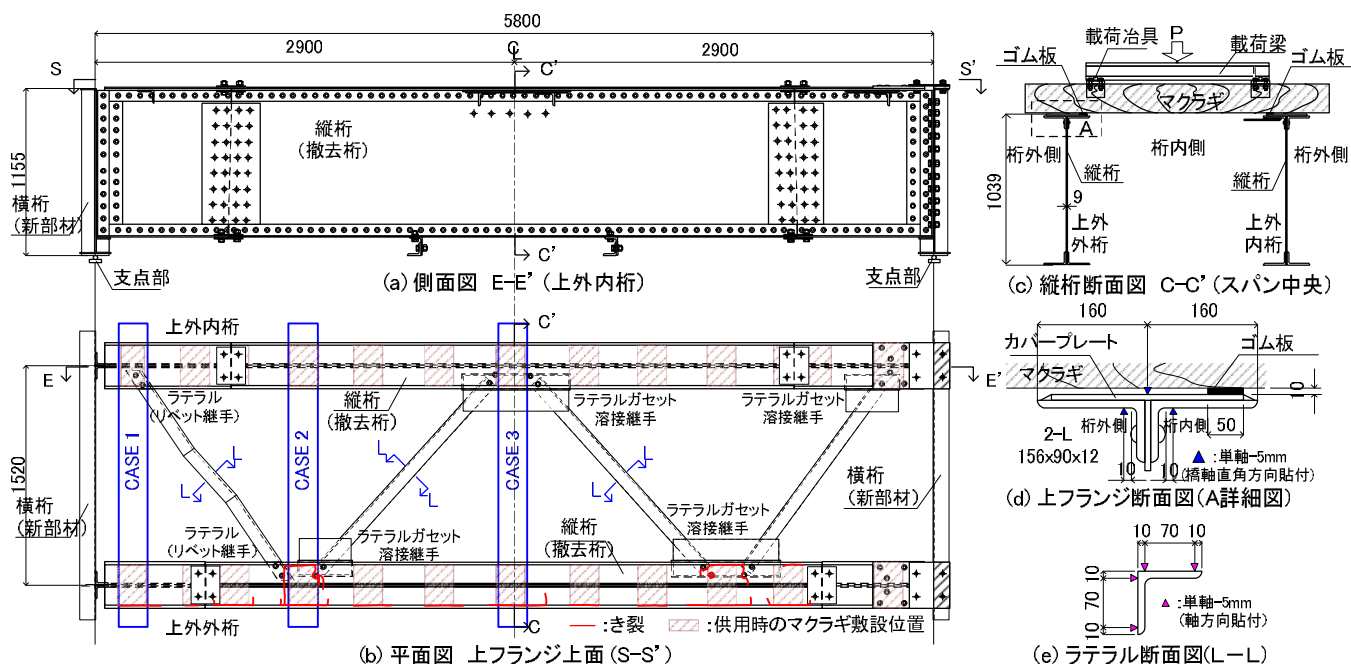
縦桁試験体の寸法と形状、ひずみゲージ貼付位置
